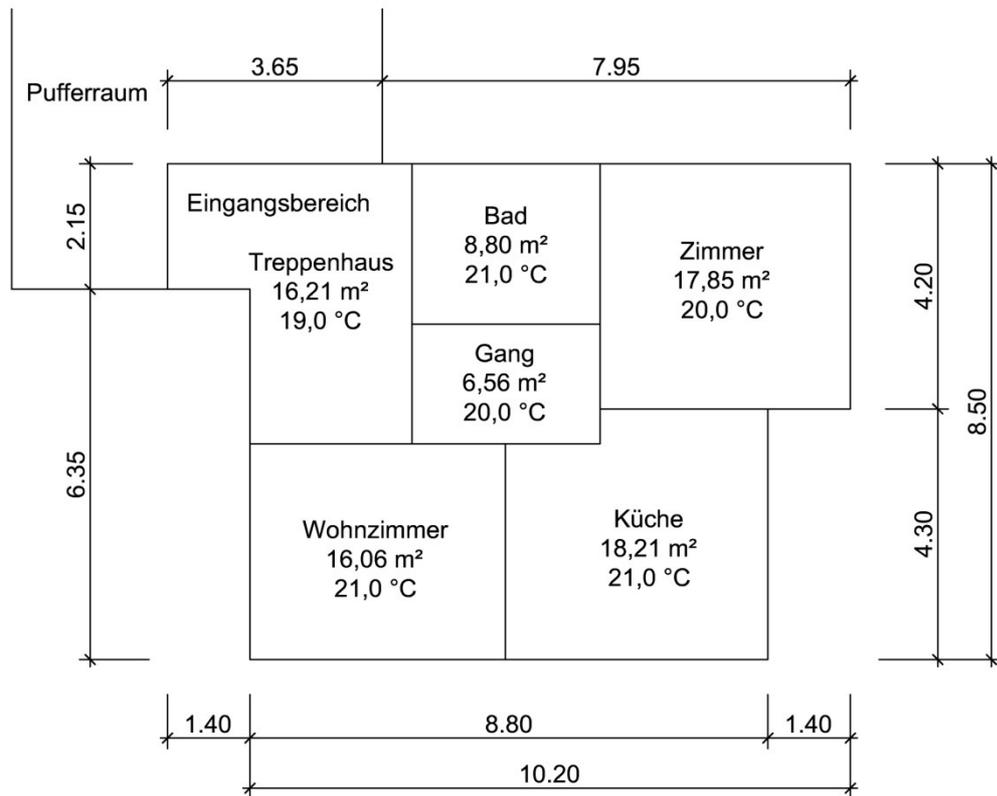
Grundriss: konditioniertes Erdgeschoss
